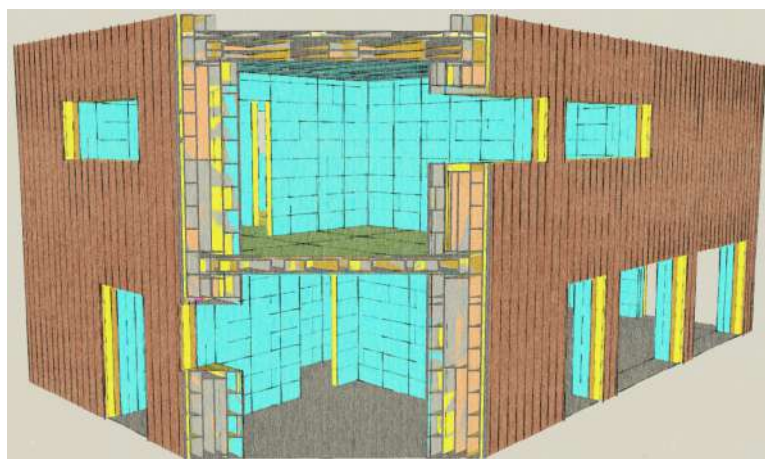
Exemple de modélisation 3D - Coupe dans la construction IsoHemp (Delvenne F. 2016)
